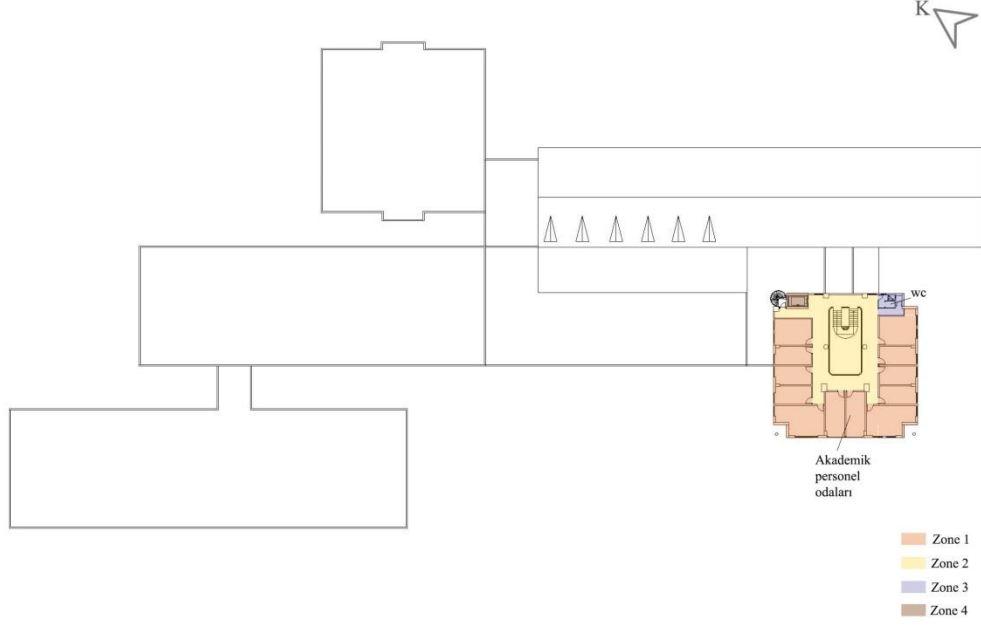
M.M.F binası bodrum kat planı ve ısıl bölgeleme.
